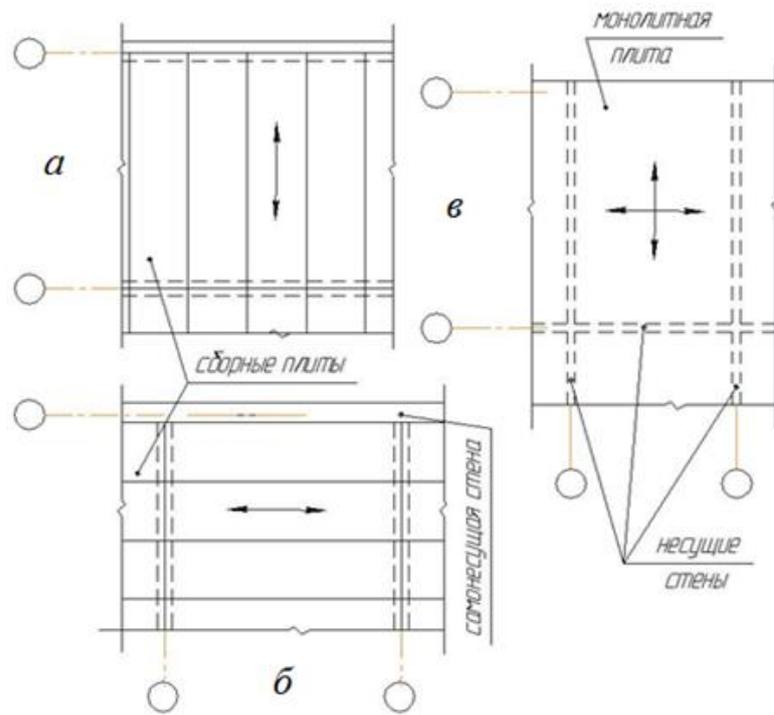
Конструктивные схемы монолитных и сборных многоэтажных зданий стеновой конструктивной системы: а – продольно-стенная, б – поперечно-стенная, в – перекрестно-стенная
